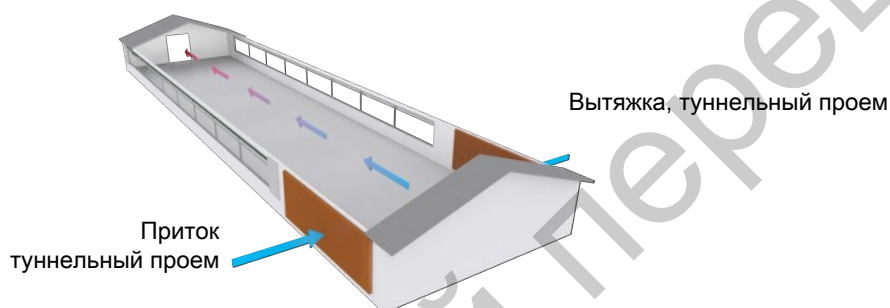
Пример естественно вентилируемого животноводческого дома в сочетании с туннельной вентиляцией, туннельной вентиляцией.
